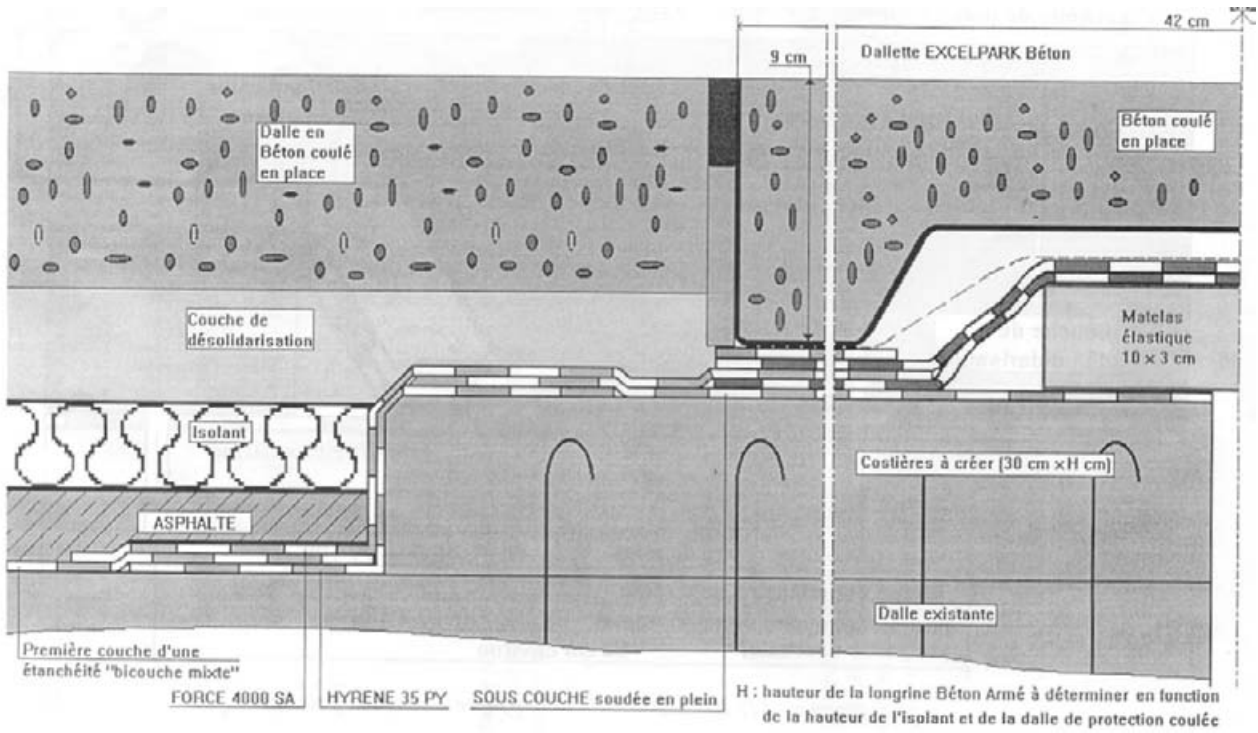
EXCELPARK 1 Béton Super / coupe de principe avec une isolation thermique inversée sur étanchéité bicouche mixte titulaire d'un Avis Technique
